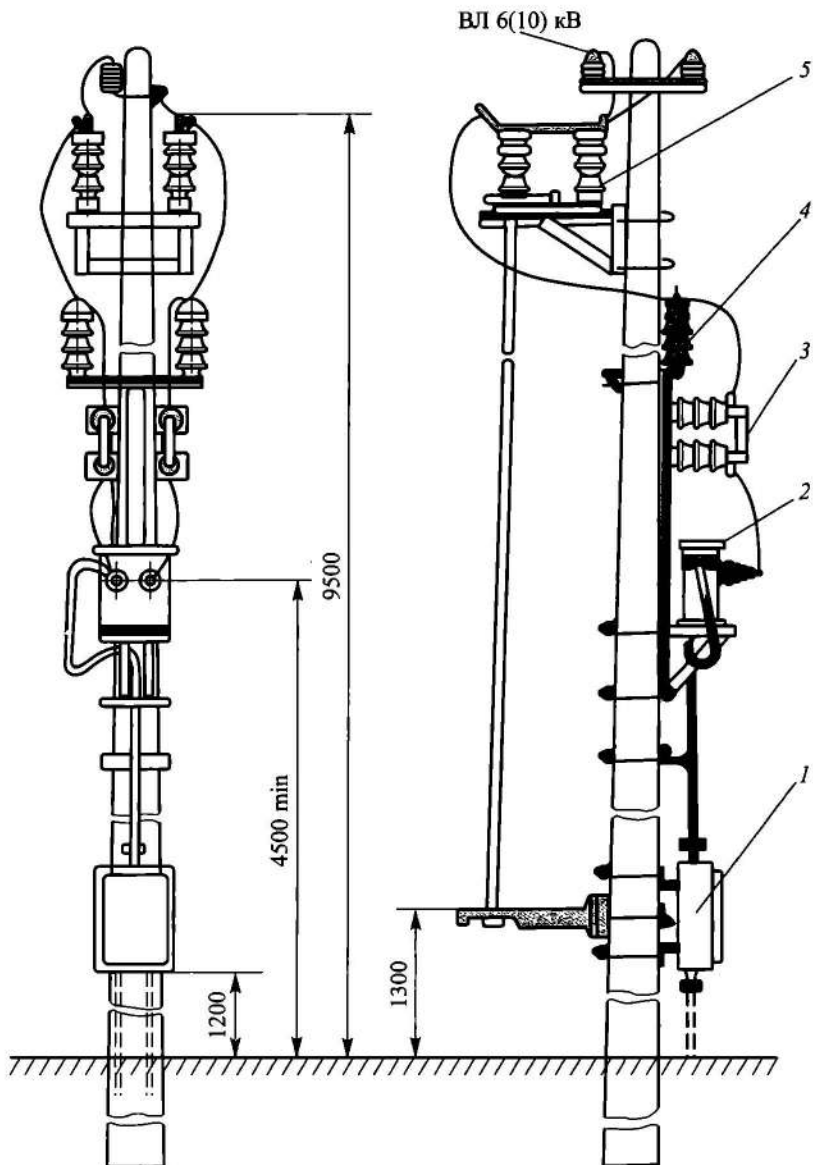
Общий вид железобетонной силовой выносной опоры:
